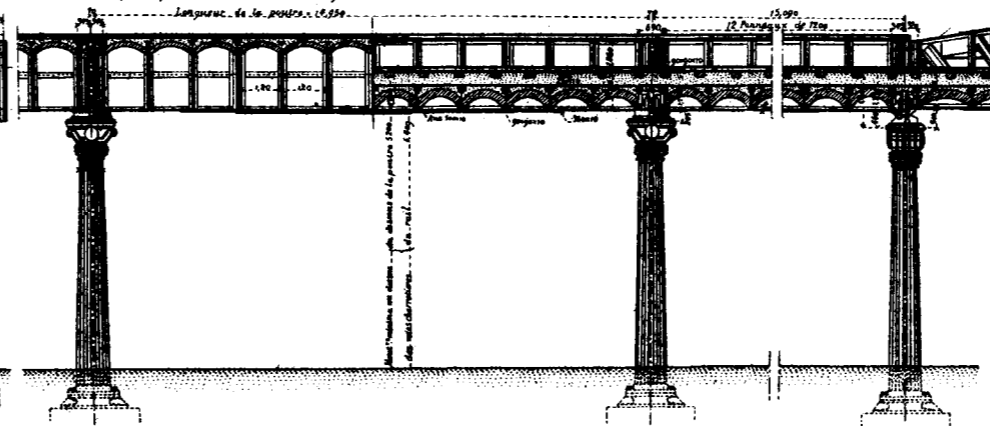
Coupe longitudinale suivant a b (Fig 4)
